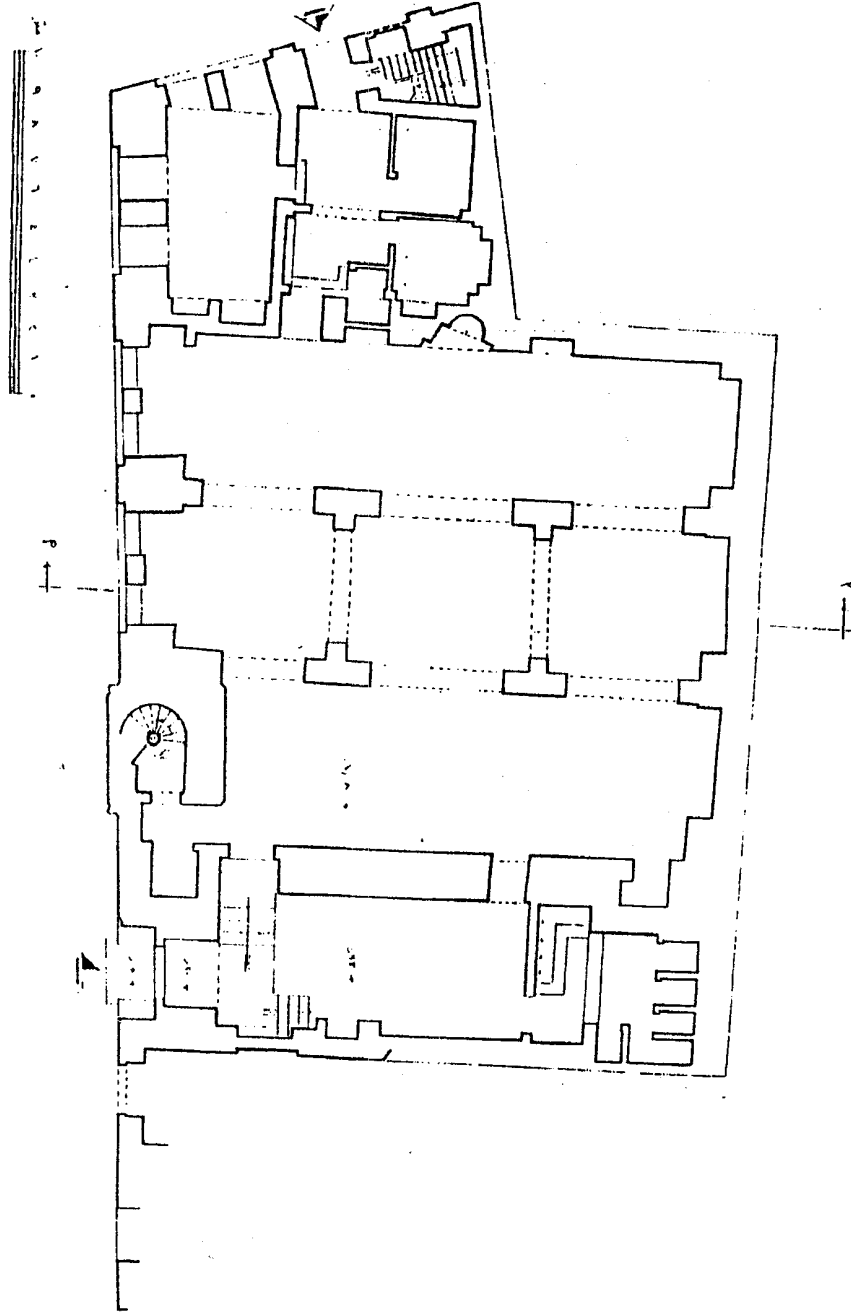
مسقط أفقي لجامع عبد الرحمن كتخدا المعروف
